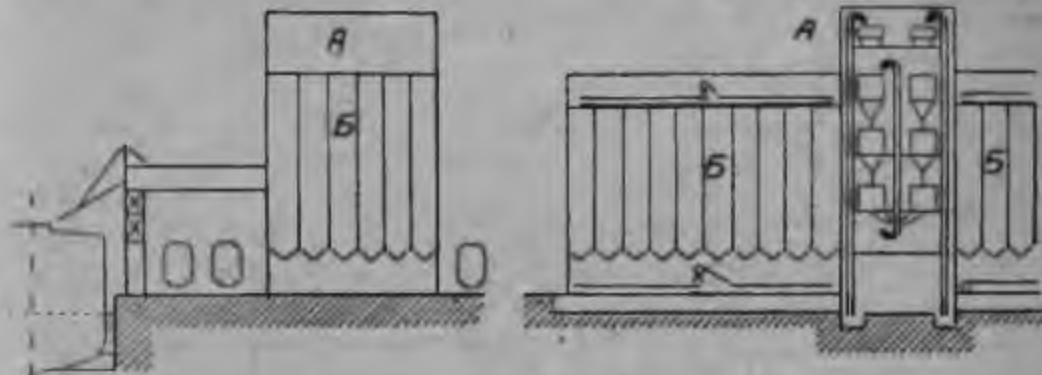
Тип европейского элеватора с рабочей башней во всю ширину корпуса в середине силосного корпуса.
